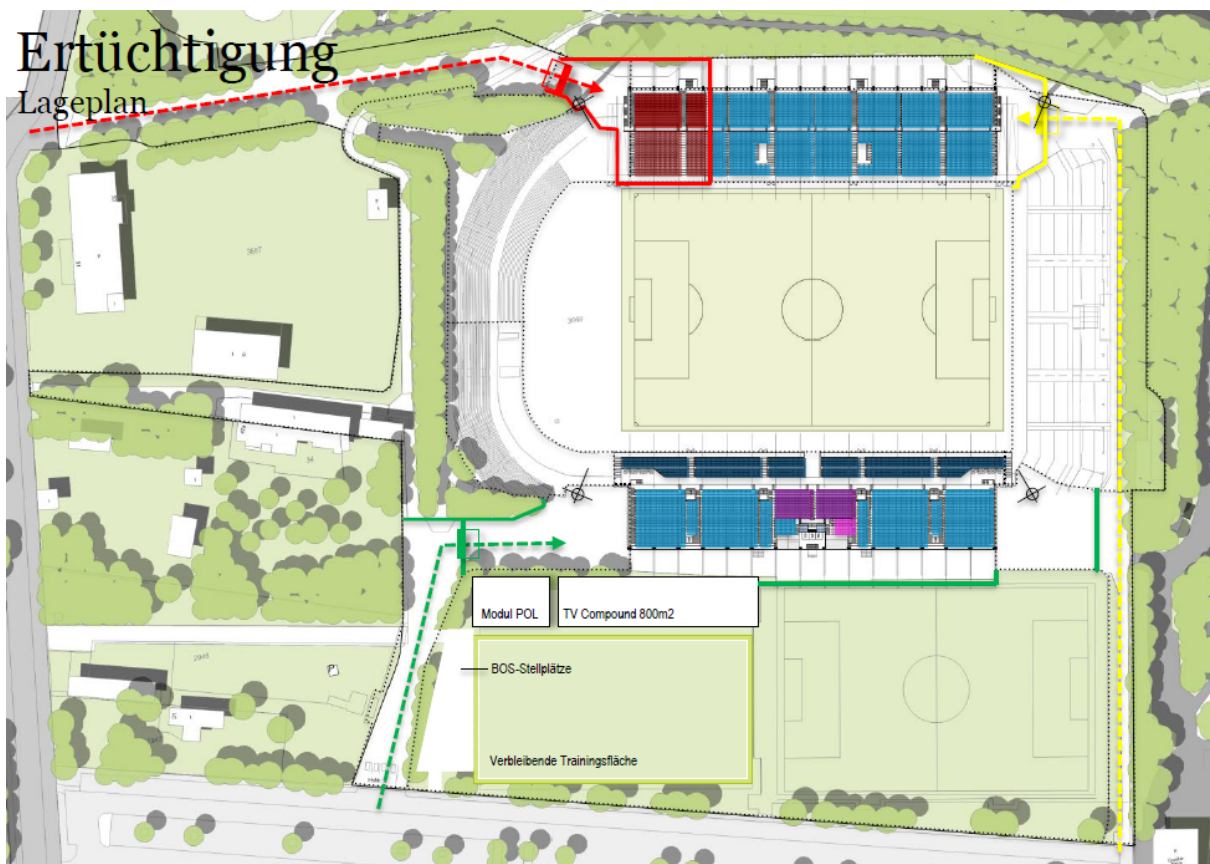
Lageplan Machbarkeitsstudie vom 29.10.2018
